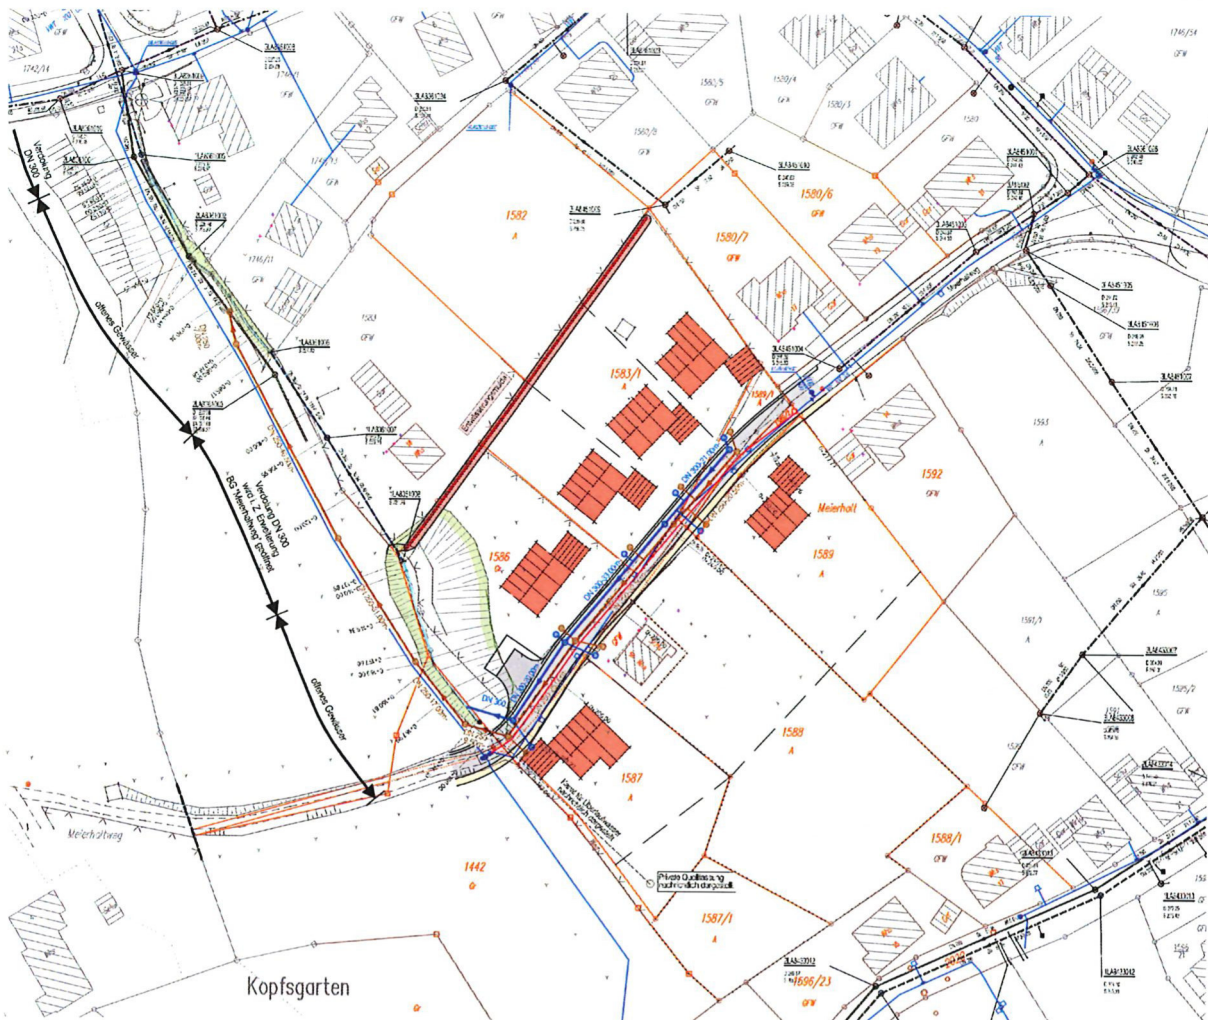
Lageplan des Entwässerungskonzepts für das Baugebiet „Meierhaltweg“
